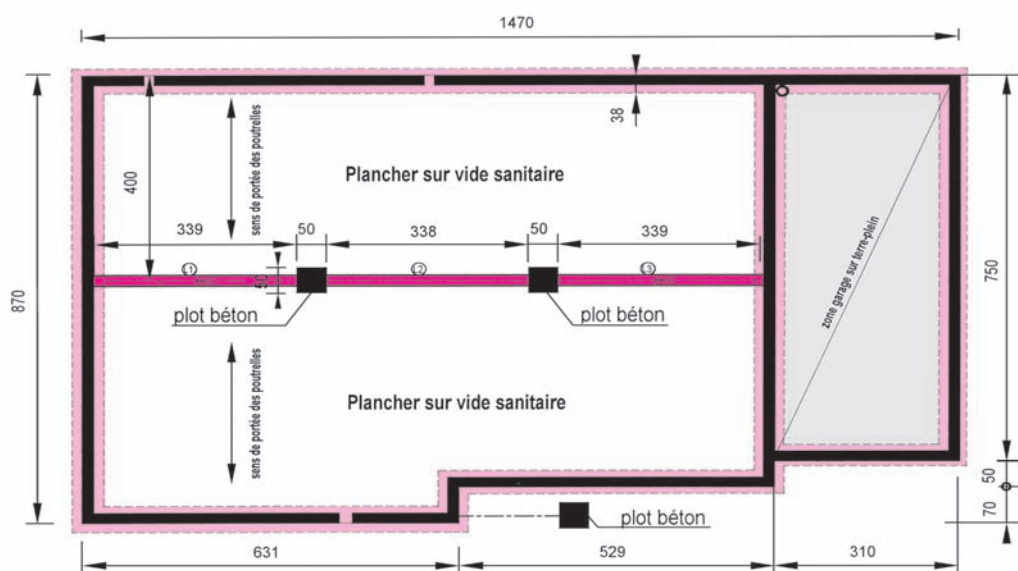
Fondations par semelles filantes en périphérie et plots bétonnés pour appuis des longrines L1, L2, L3
